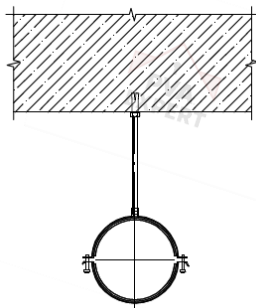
Узел крепления канализационной трубы к перекрытию
